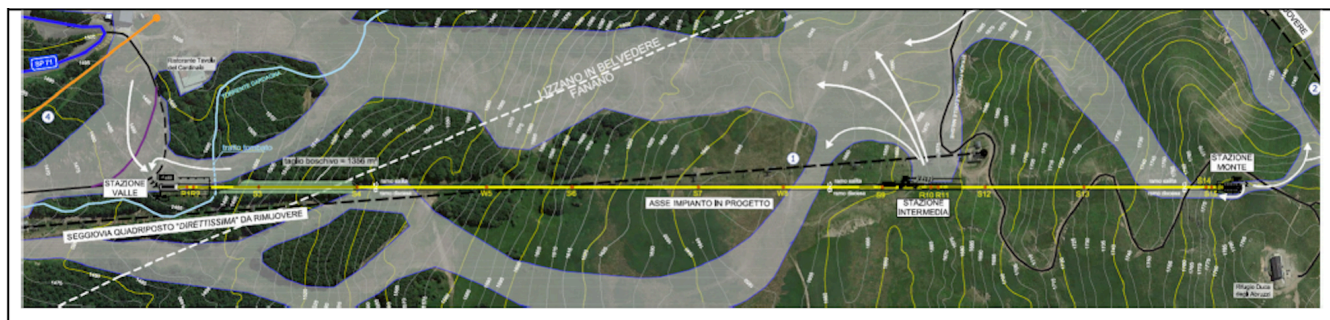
Individuazione taglio boschivo, planimetria generale
